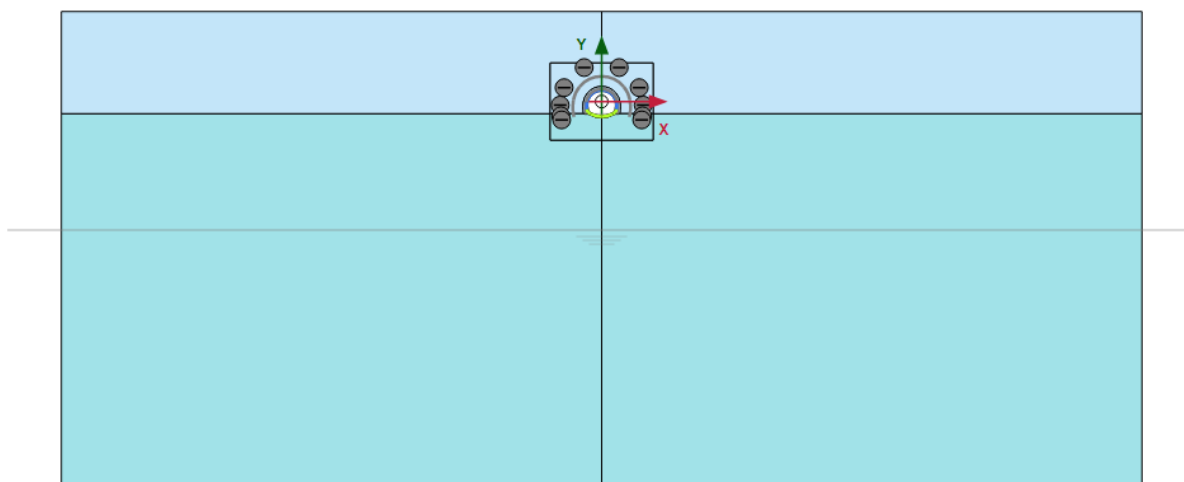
Sezione B3. – Modello di calcolo - Geometria
